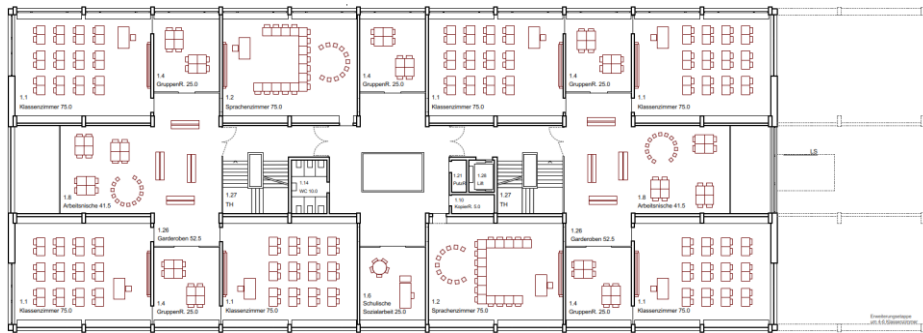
Grundriss 3. Obergeschoss (Regelgeschoss)
